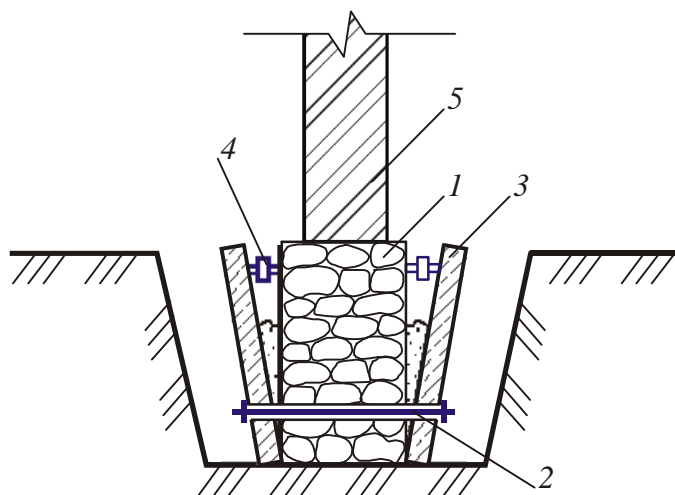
Увеличение площади опирания фундаментов с помощью железобетонных отливов: 1 – фундаментов; 2 – стальной тяж; 3 – железобетонный отлив; 4 – домкрат; 5 – стена
